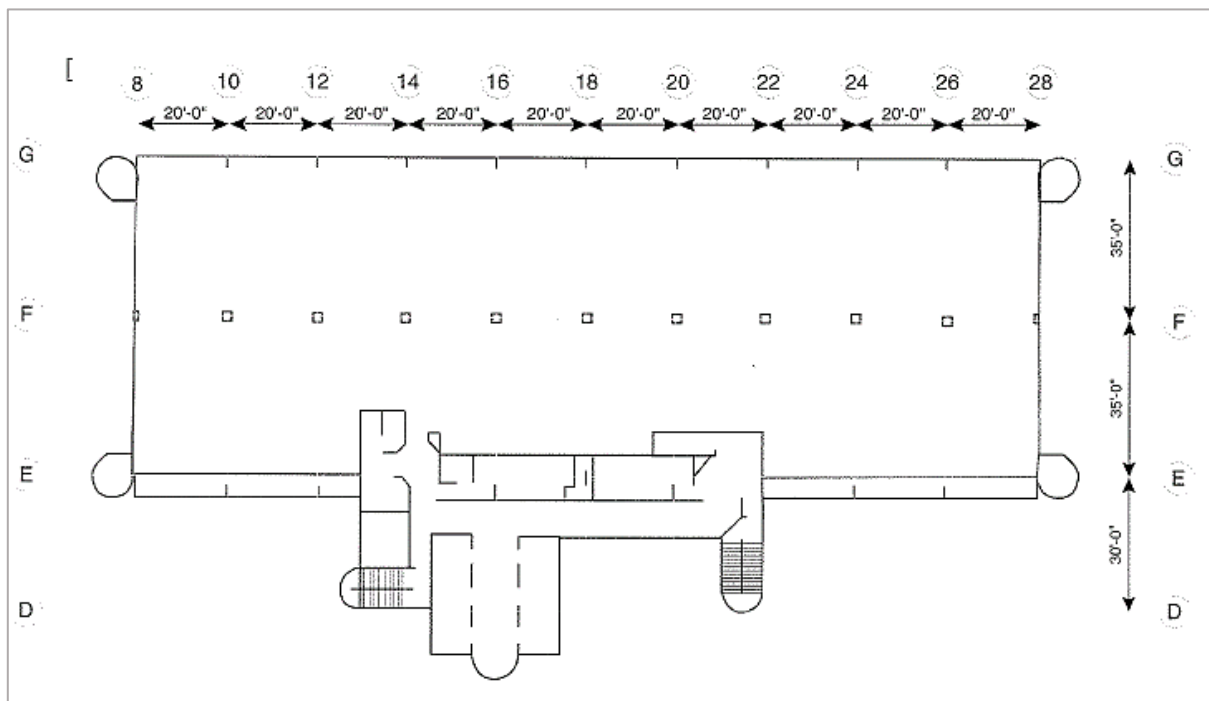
Croquis en planta de la distribución de las columnas en la estructura [22].
